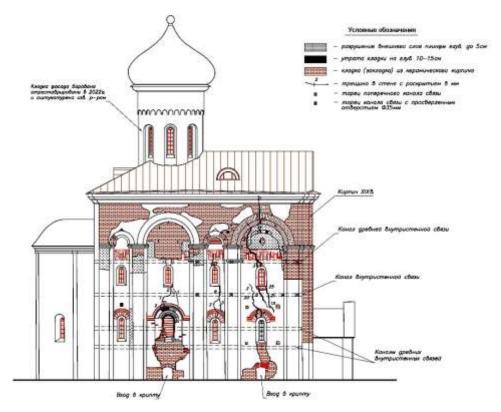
Северный фасад в 2023 г. после демонтажа поздних слоёв штукатурки
